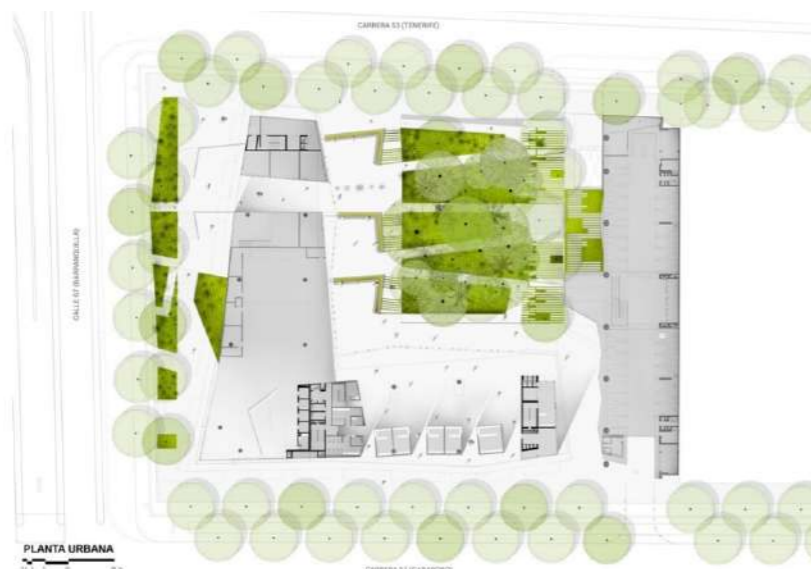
, Planta arquitectónica de la Ruta N en Medellín.
